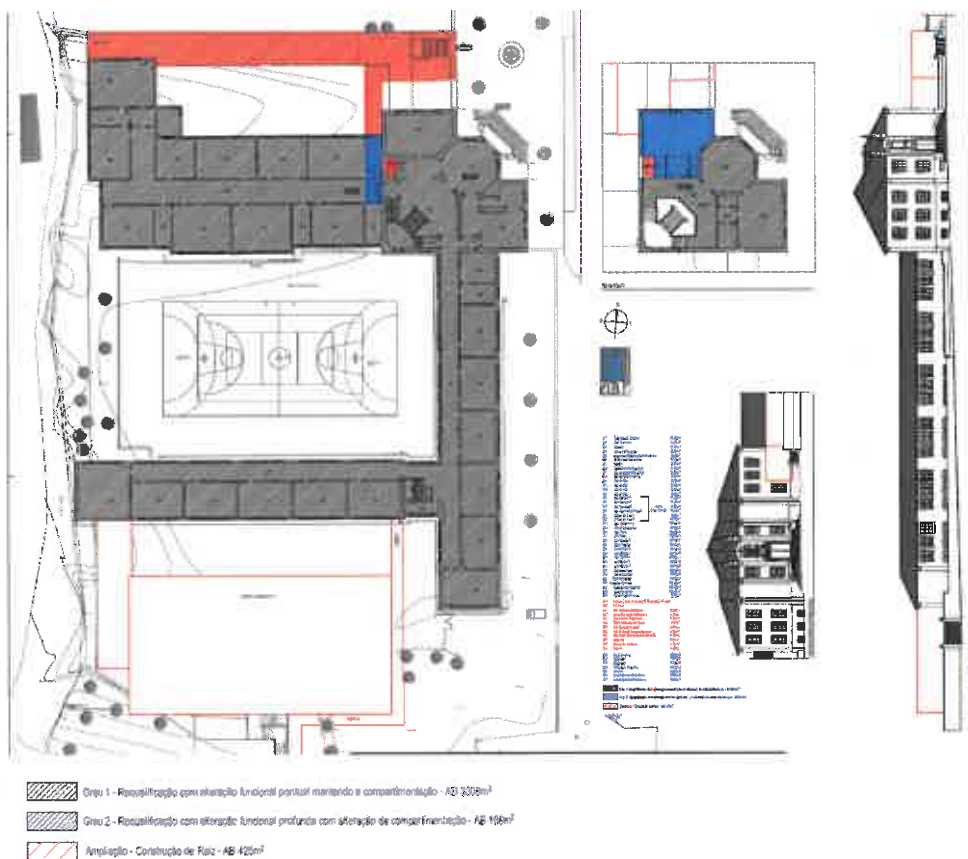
| Intervenção proposta – Planta nível 0 Edifício Principal e novo pavilhão + Corte Alçado
